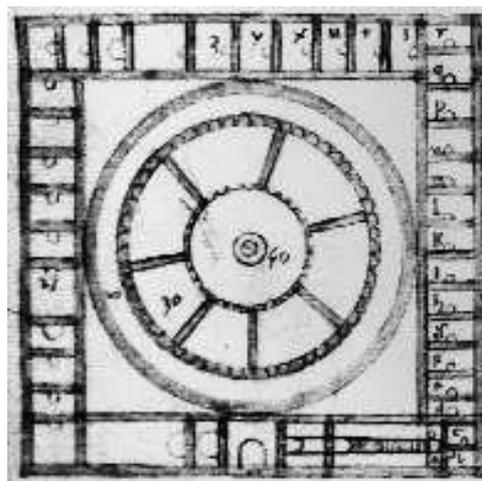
Filarete, Haus der Tugend und des Lasters, Grundriß
